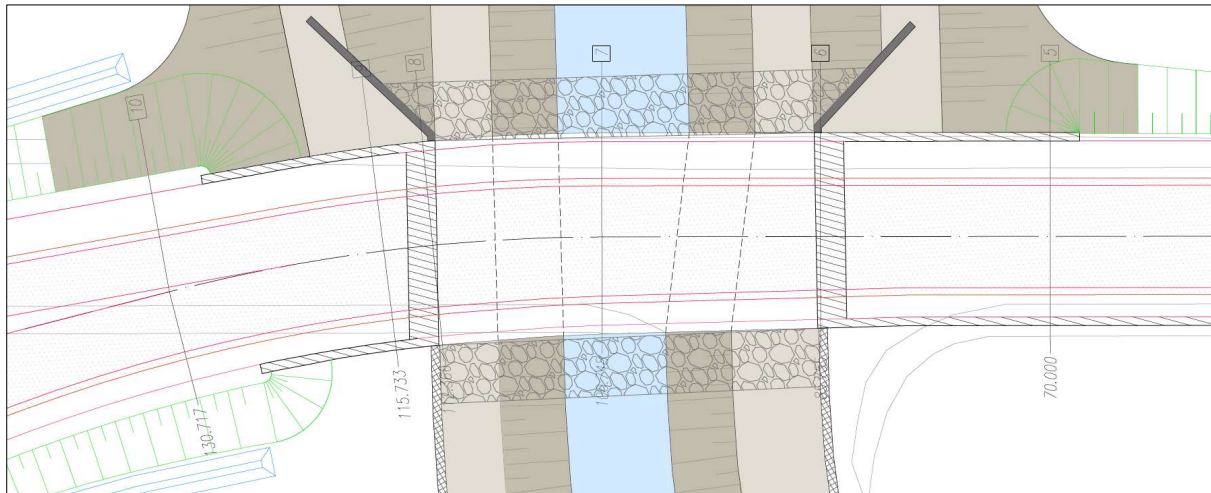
Stralcio planimetrico Ponte sul Fosso Reale
